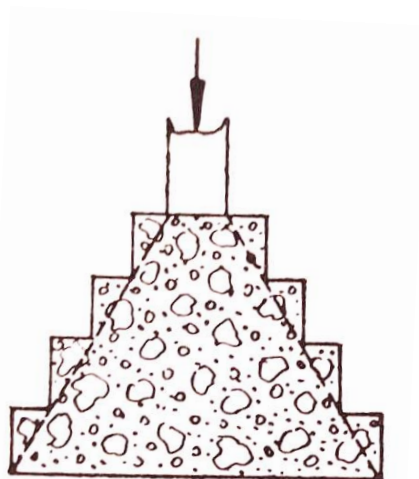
Bloco de fundação (Caputo, 1988).
